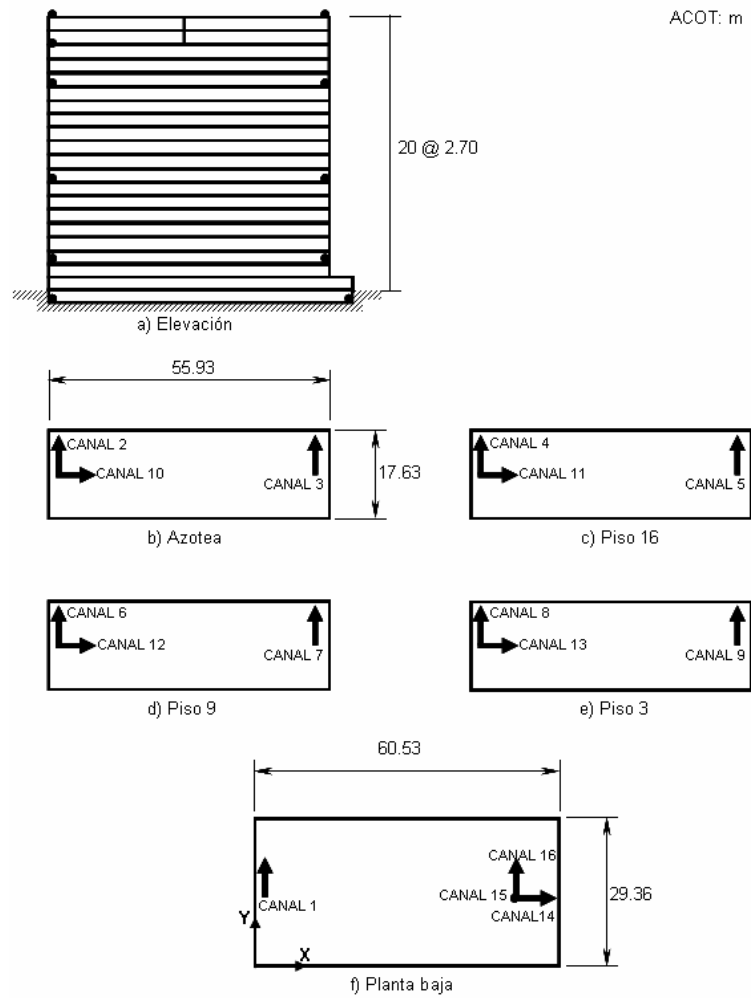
Geometría y puntos de instrumentación del edificio North Hollywood-20 (Naeim, 1997)
